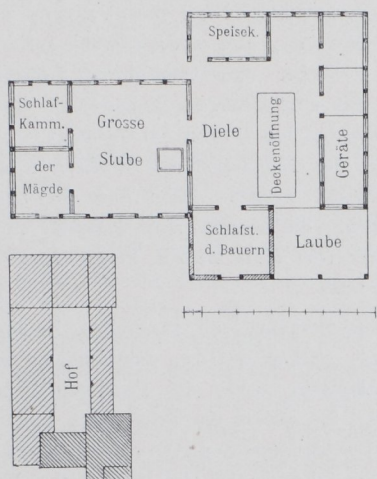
und 8. Bauernhaus aus Kleefeld. Kr. Braunsberg. Grundriß und Lageplan.
